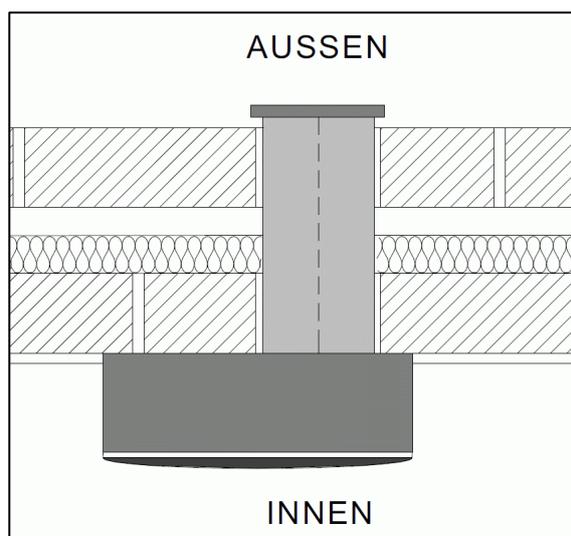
Detail B, Lüftungsanlage mit Aufputzmontage
